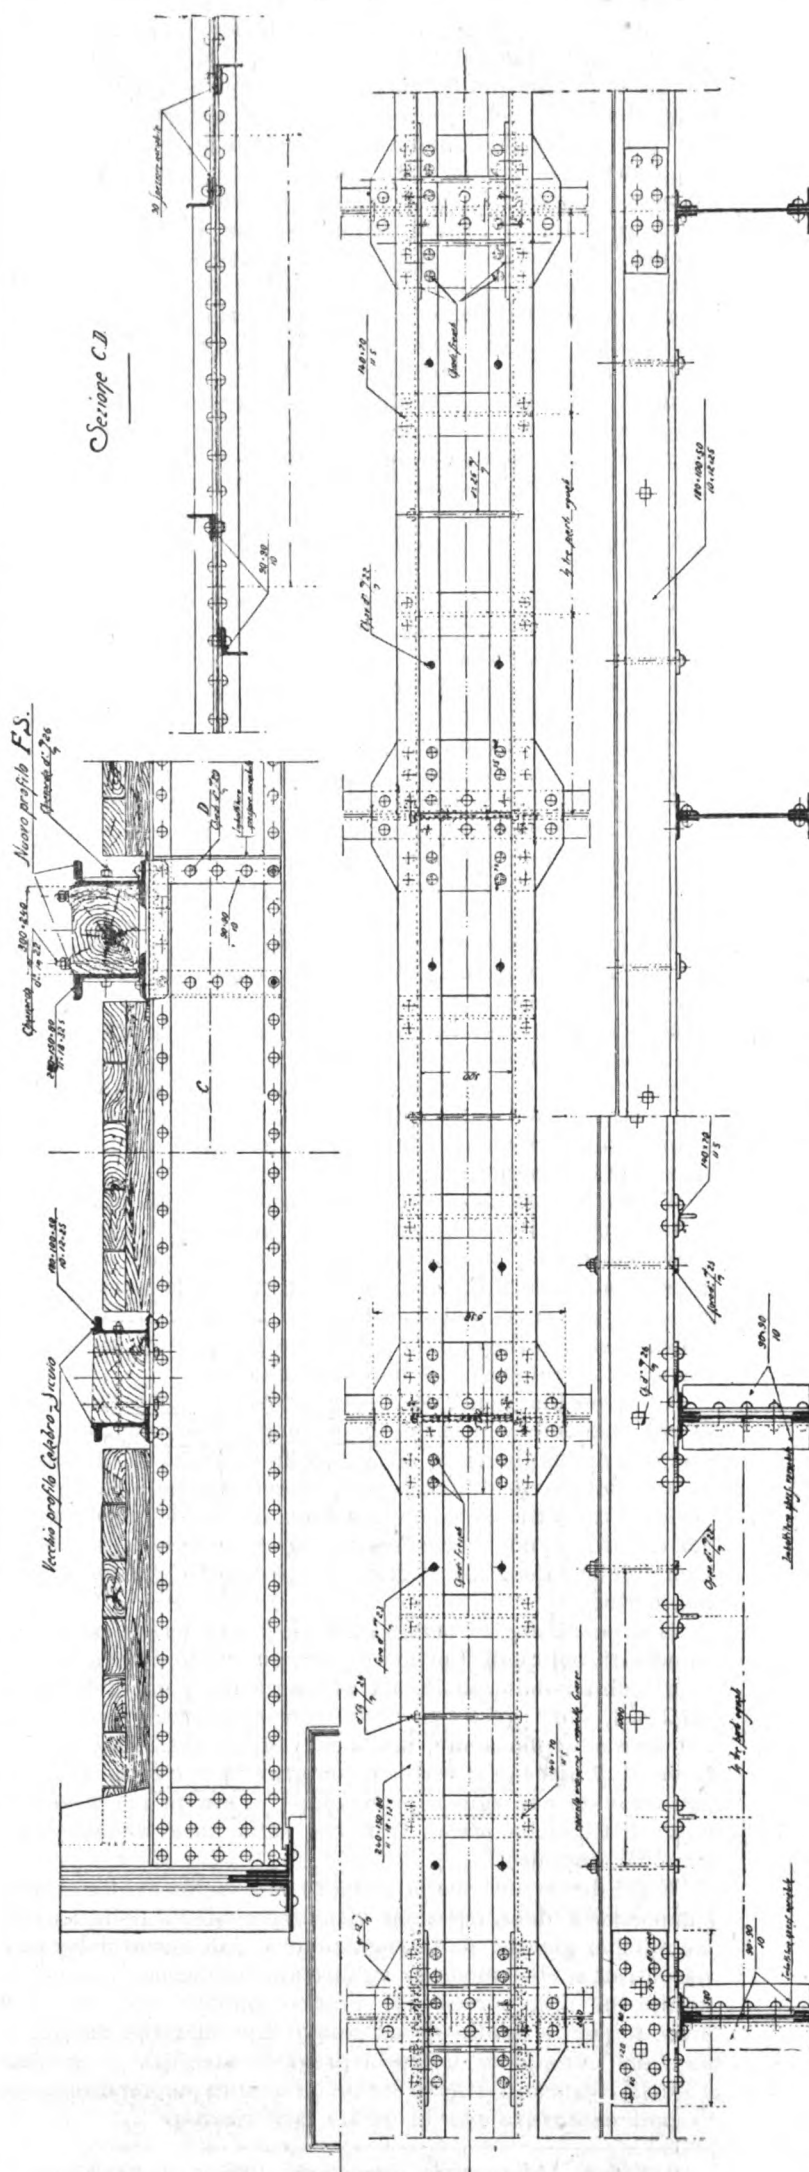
, 19 e 20. -- Nuovo profilo di travi in ferro delle F. S. - Sezioni e pianta
